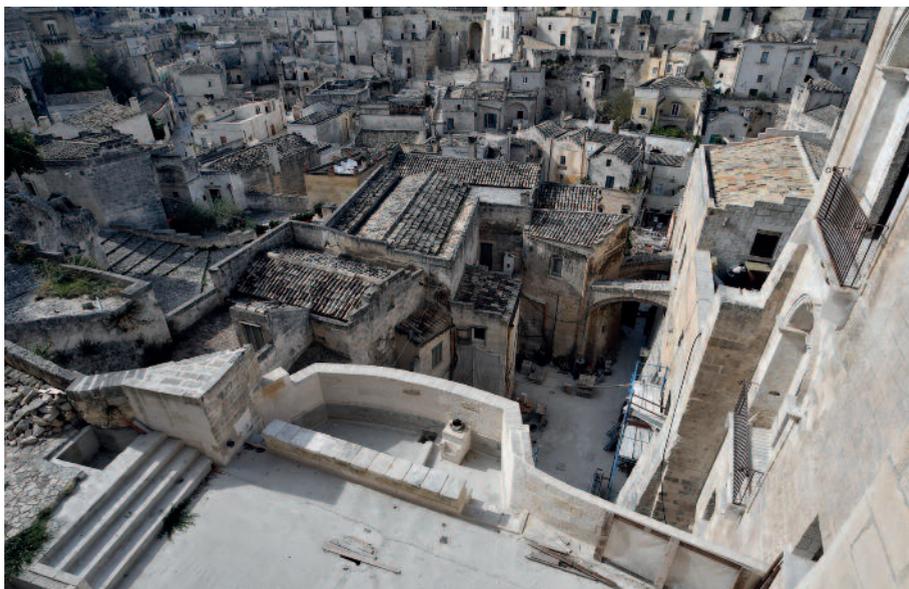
Matera, Sasso Barisano: particolare dell'alto massetto in calcestruzzo della nuova pavimentazione pubblica (foto di Roberto Nadalin).
